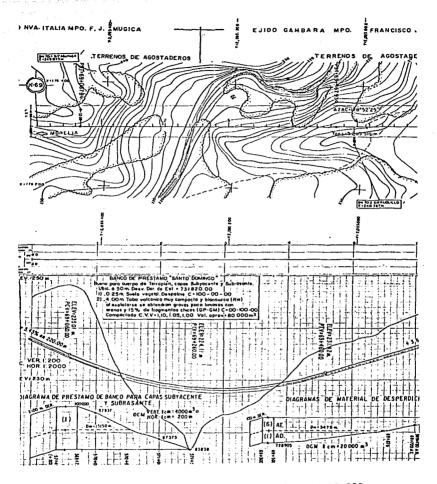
Planta y perfil de est. 69+000 a est. 69+600
